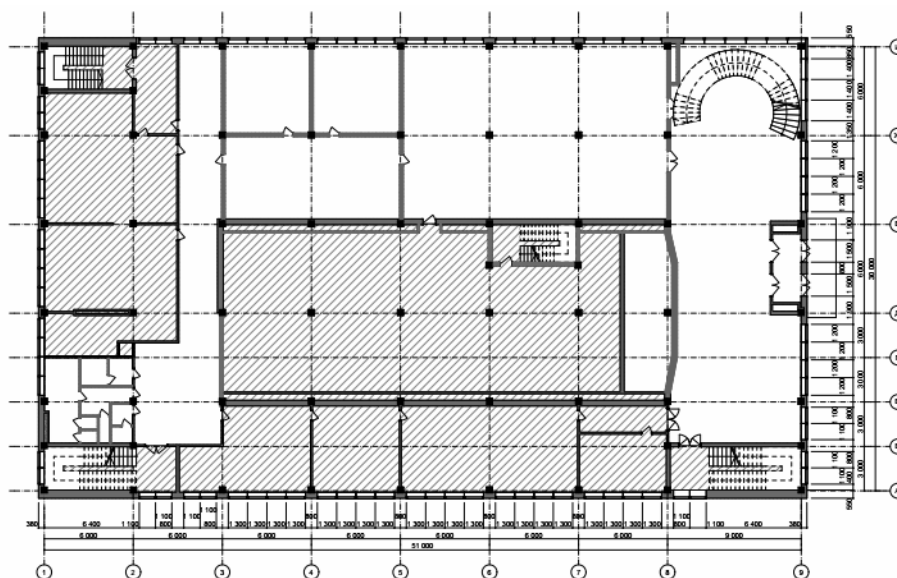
План до перепланування 1-го поверху науково-дослідницької бібліотеки
